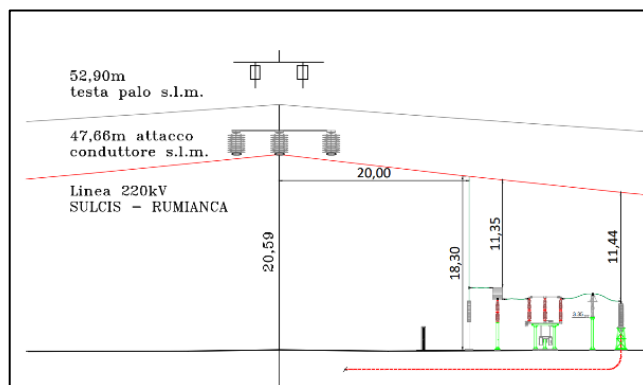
Sezione SE provvisoria (Fonte: ALL7_SE Planimetria Elettromeccanica)
